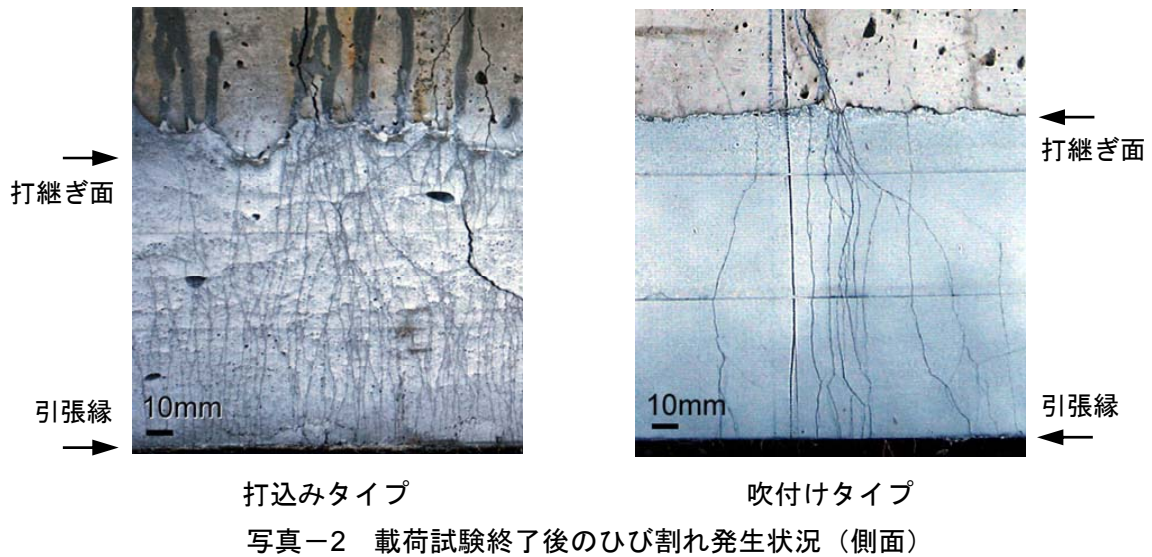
載荷試験終了後のひび割れ発生状況（側面）
